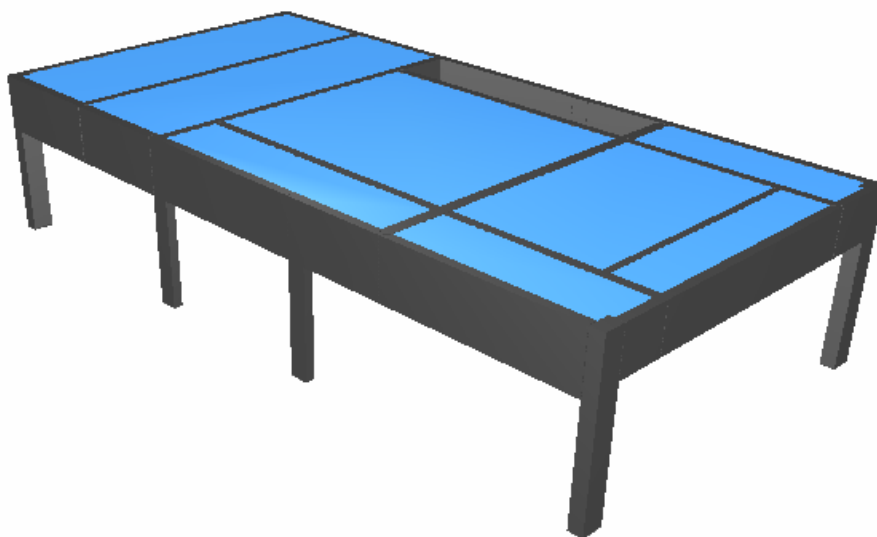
Vista em perspectiva da estrutura da laje do térreo (região afetada).
